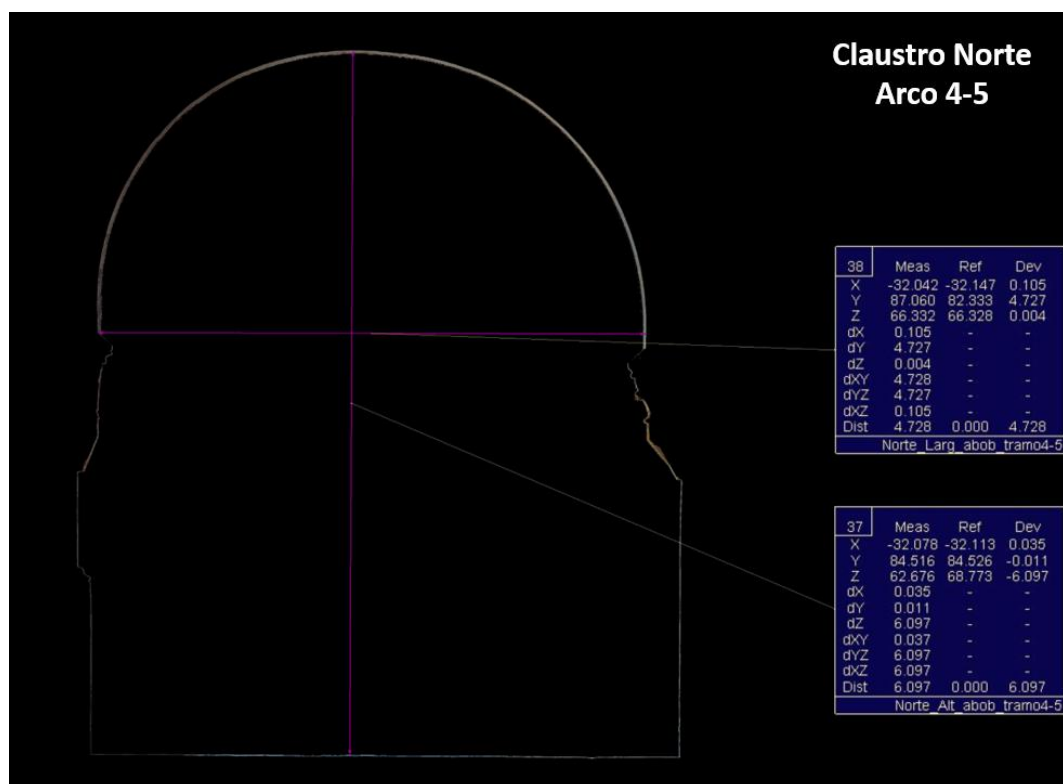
Corte transversal do Arco 4-5 do claustro Norte de D. Dinis.
